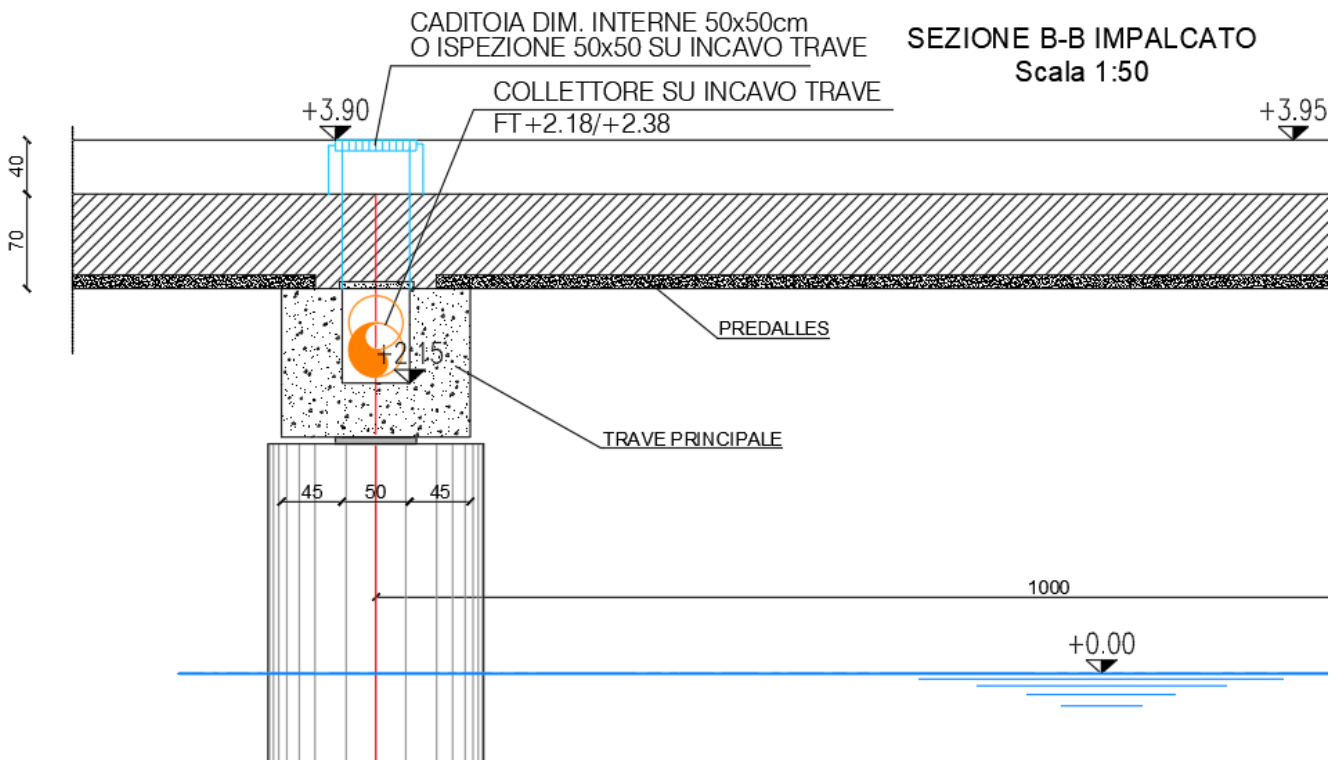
Sezione longitudinale tipo della raccolta acque da bordo banchina
